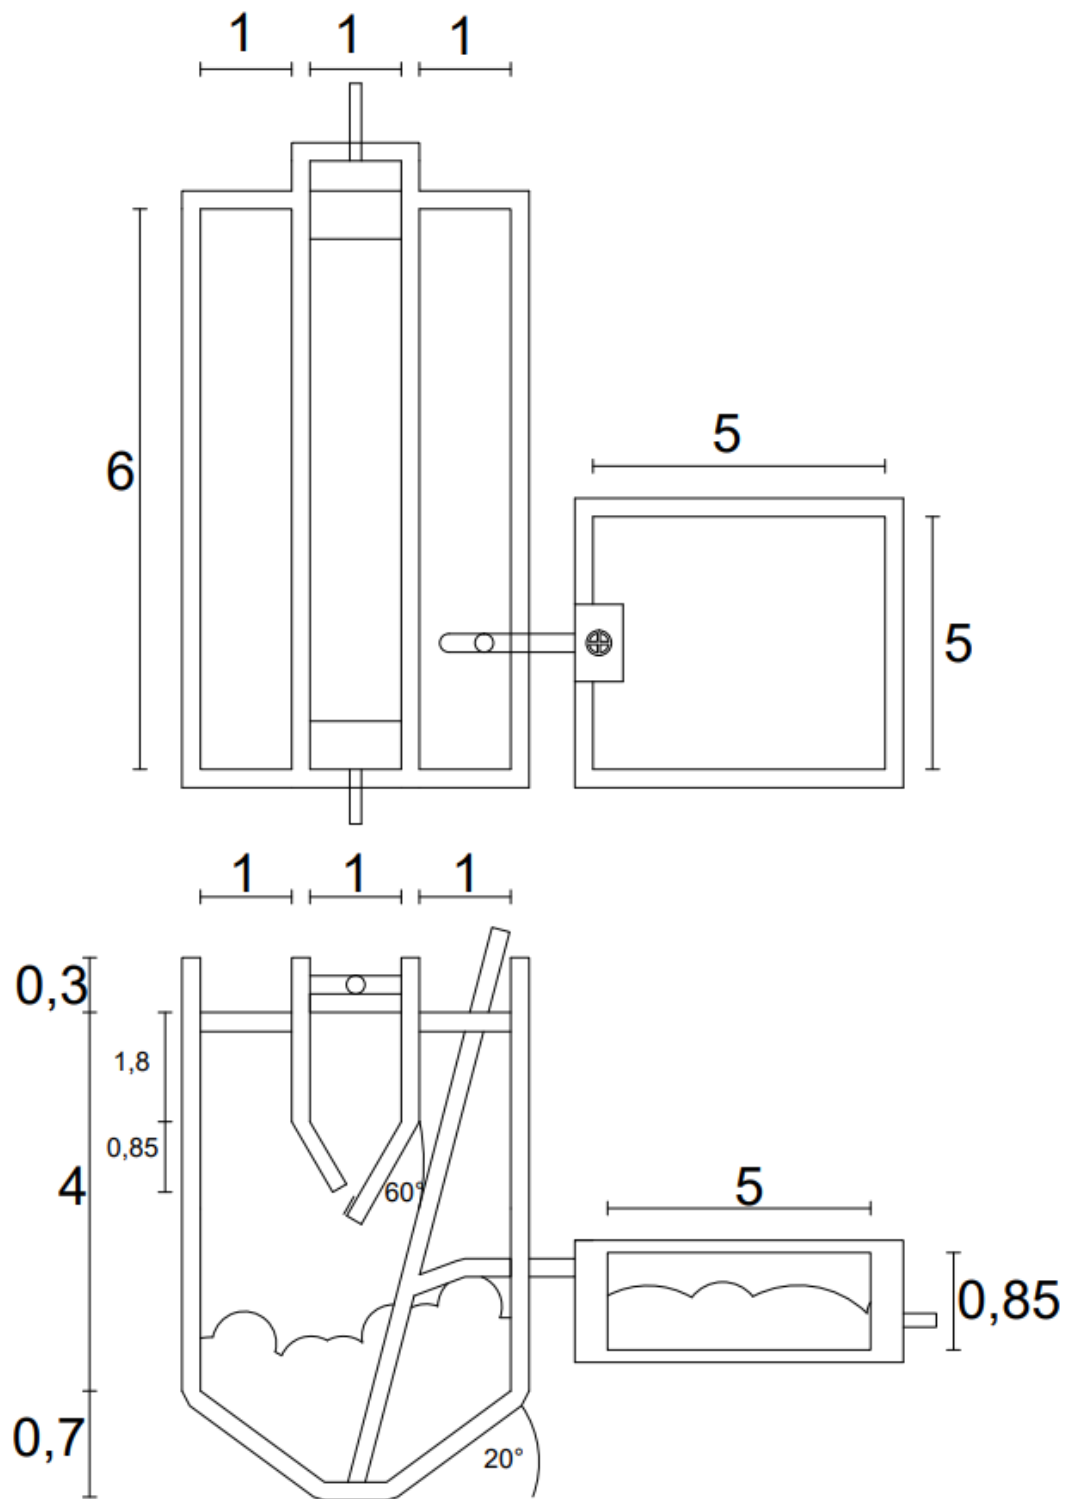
Esquema vertical y planta con dimensiones del tanque Imhoff en metros.
